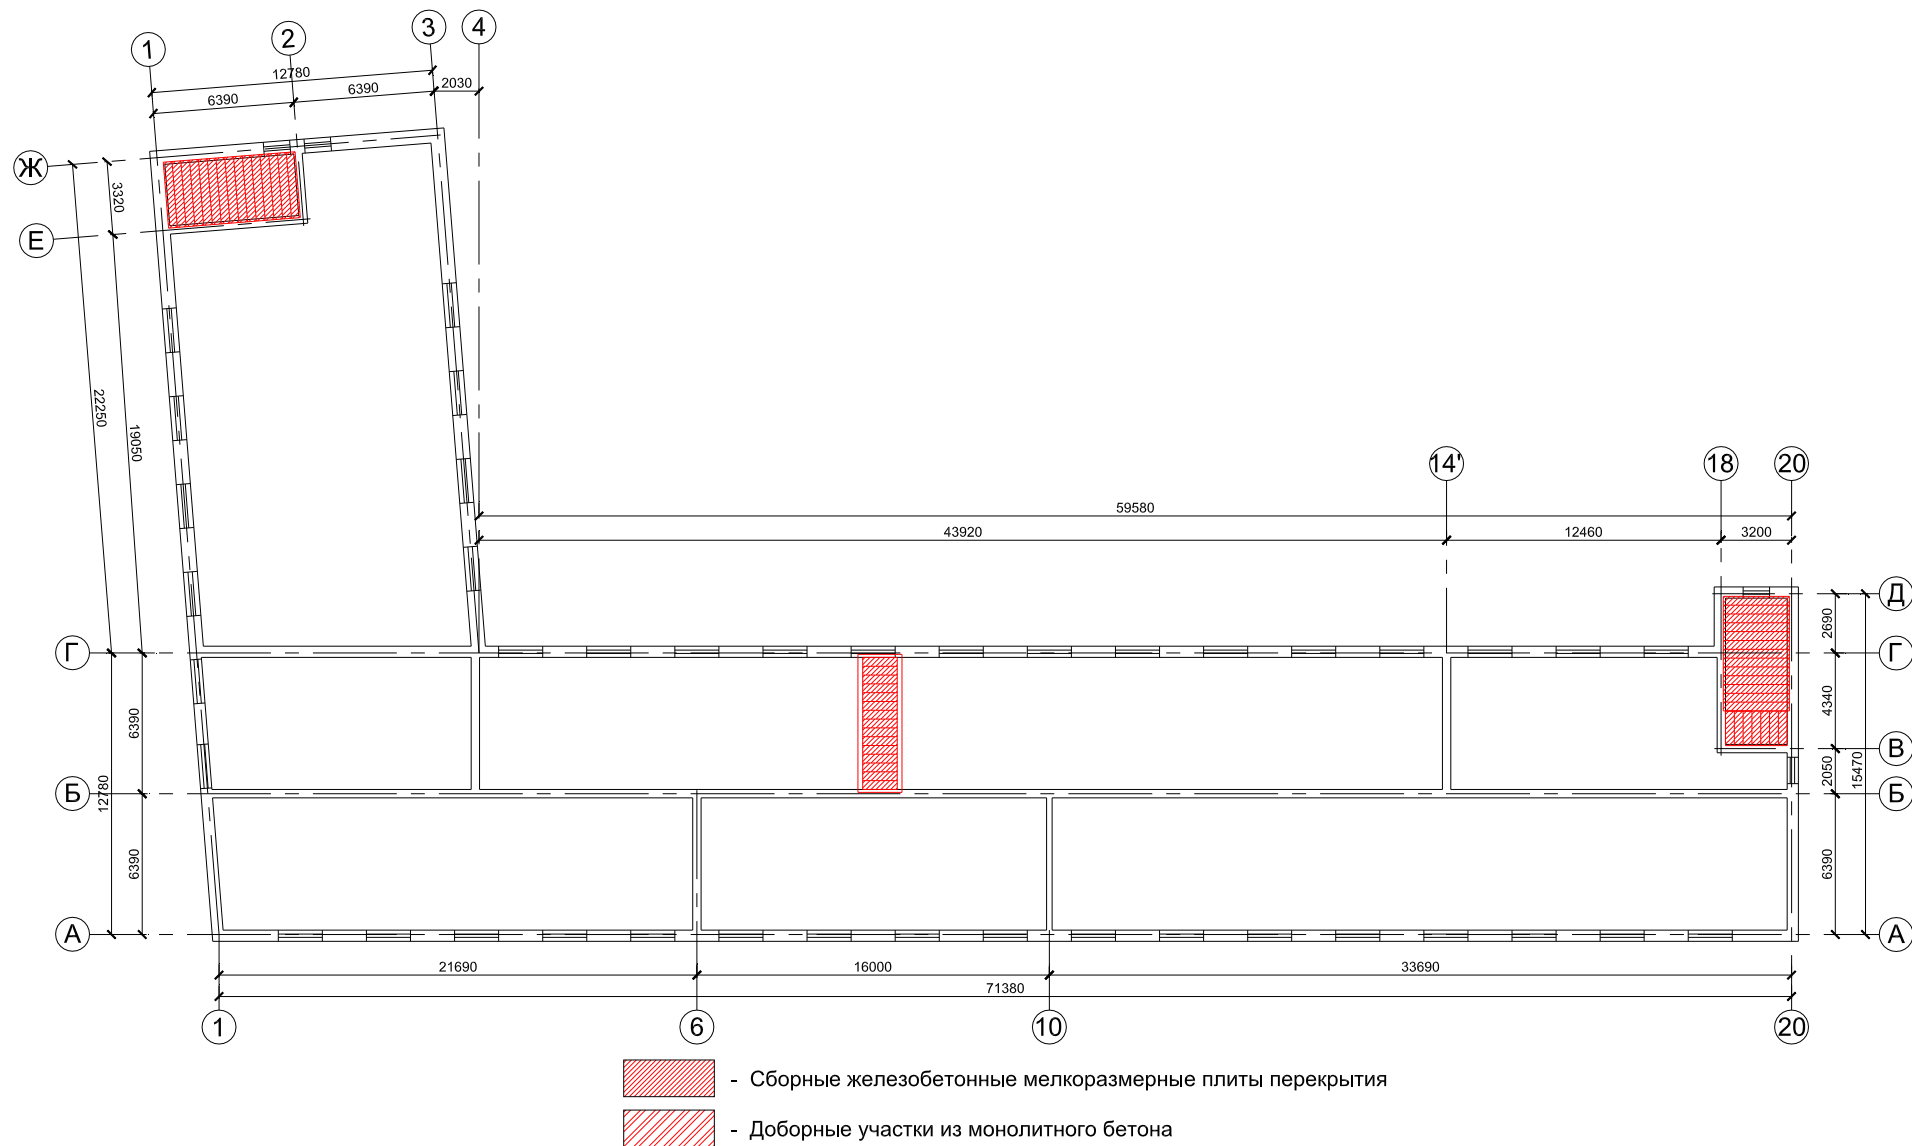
Схема раскладки плит перекрытия над лестничными клетками и лифтовой шахтой здания.
